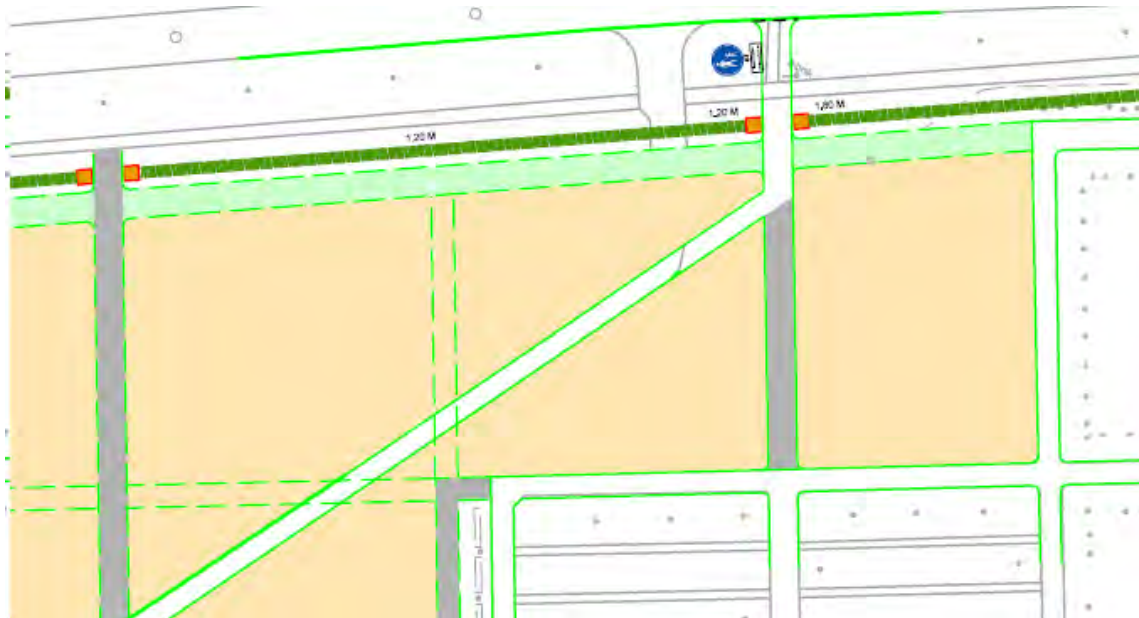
situatie inpassing aan de Planetenhof met boombeplanting (bron: gemeente Maastricht)
